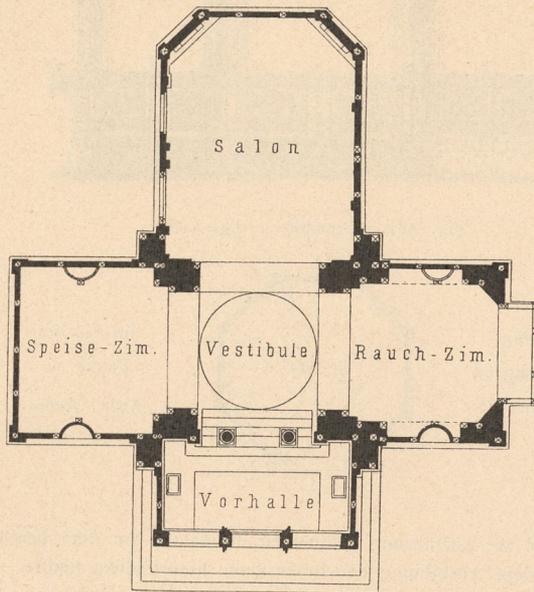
Grundriss. — 1/250 n. Gr.
